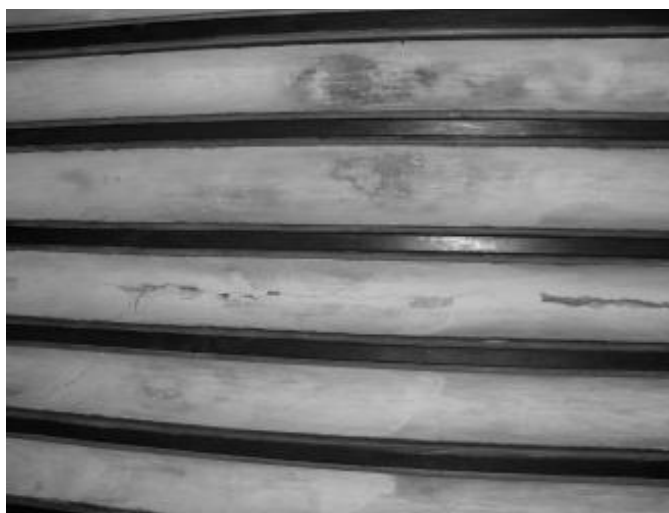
Ejemplo de forjado unidireccional realizado con viguetas de madera que encontramos en San Bonaventura.¹ (Collado Espejo, 2009). Pág. 125.
